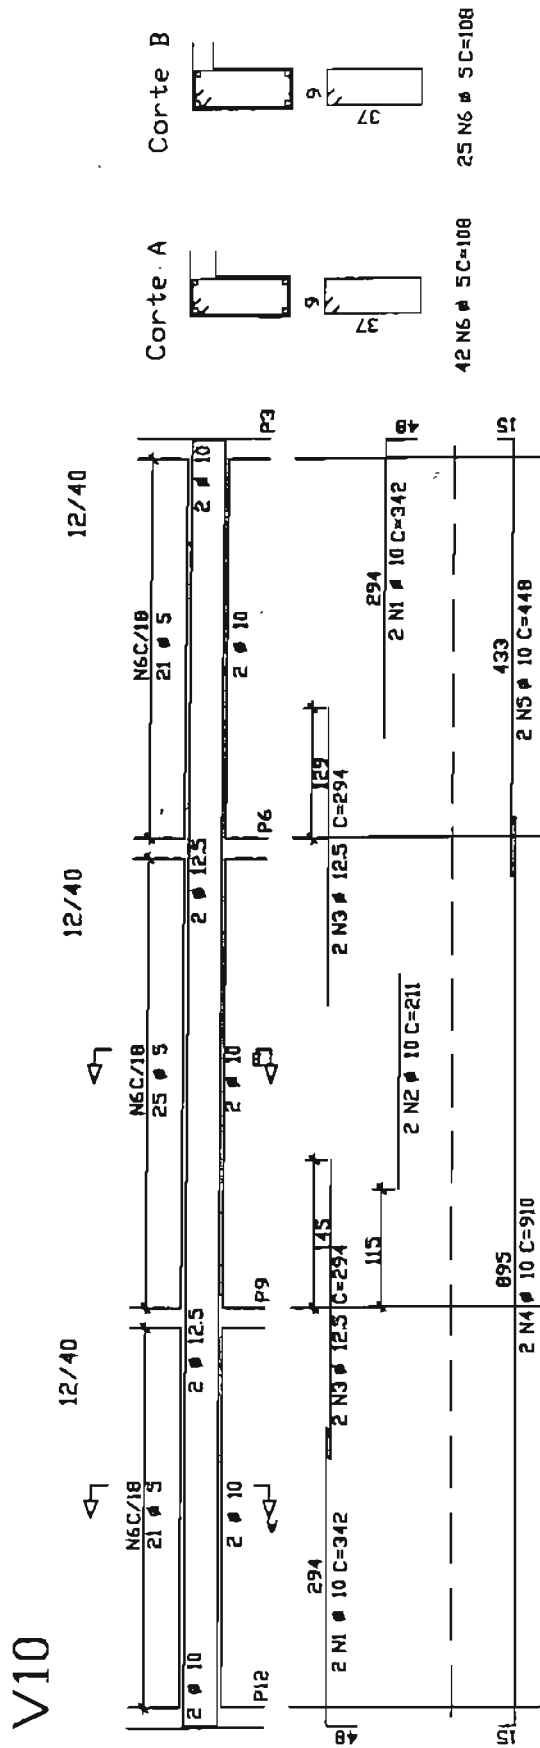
Detalhe de armadura da viga V10 (pórtico simplificado)
